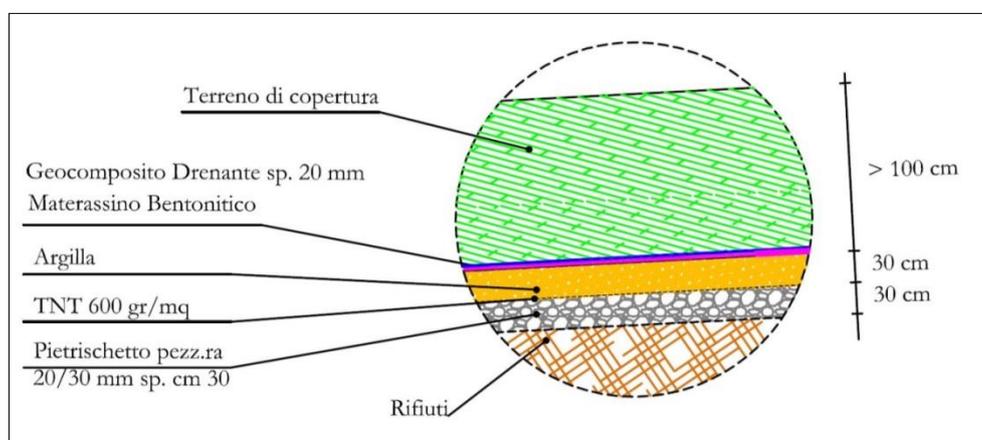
7 – Schema del pacchetto di copertura finale autorizzato
